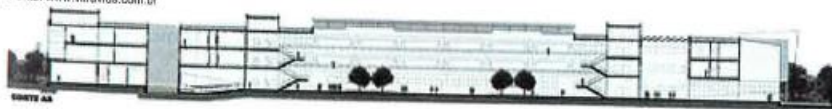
CORTE LONGITUDINAL DO BLOCO ACADÊMICO
